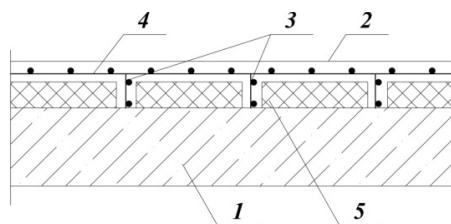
Устройство железобетонного наращивания в виде кессонной плиты [1]:
